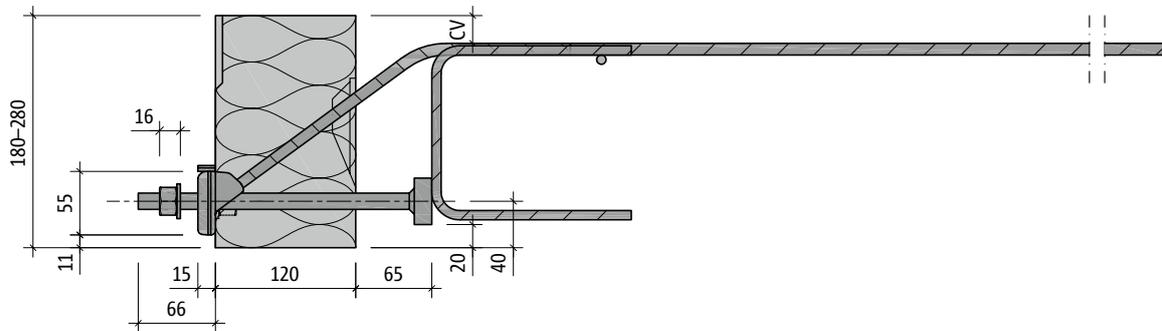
Schöck Isokorb® XT tipo SQ-V2: Sección del producto
